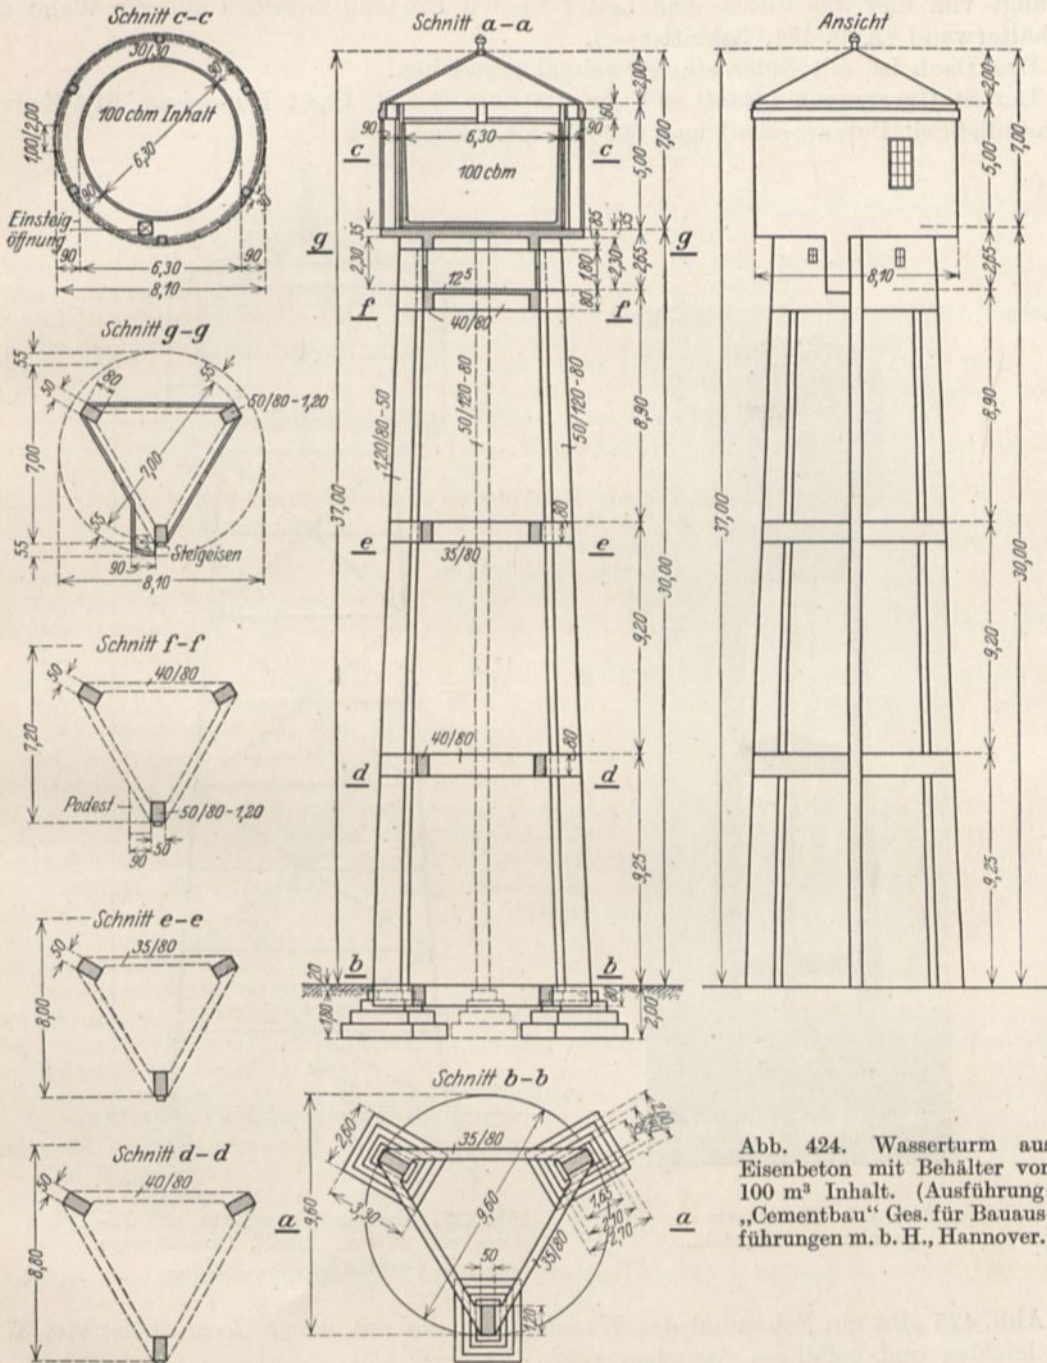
Wasserturm aus Eisenbeton mit Behälter von 100 m<sup>3</sup> Inhalt. (Ausführung: „Cementbau“ Ges. für Bauausführungen m. b. H., Hannover.)
